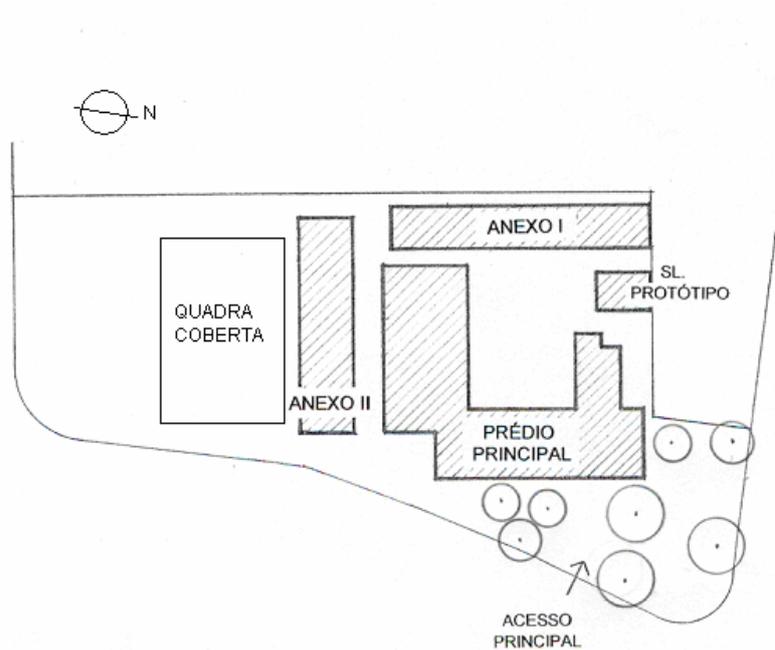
E.M. Dilermando Cruz - Planta de Situação Esquemática
